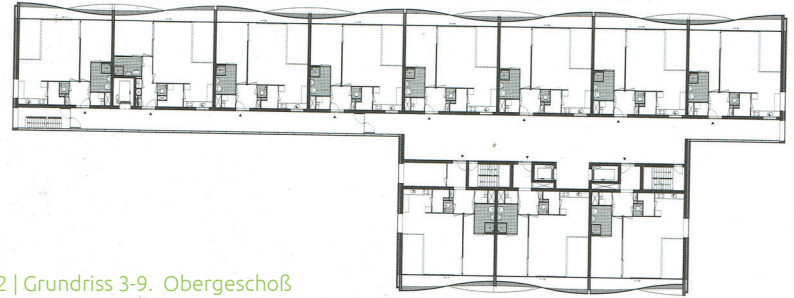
| Grundriss 3-9. Obergeschoß
